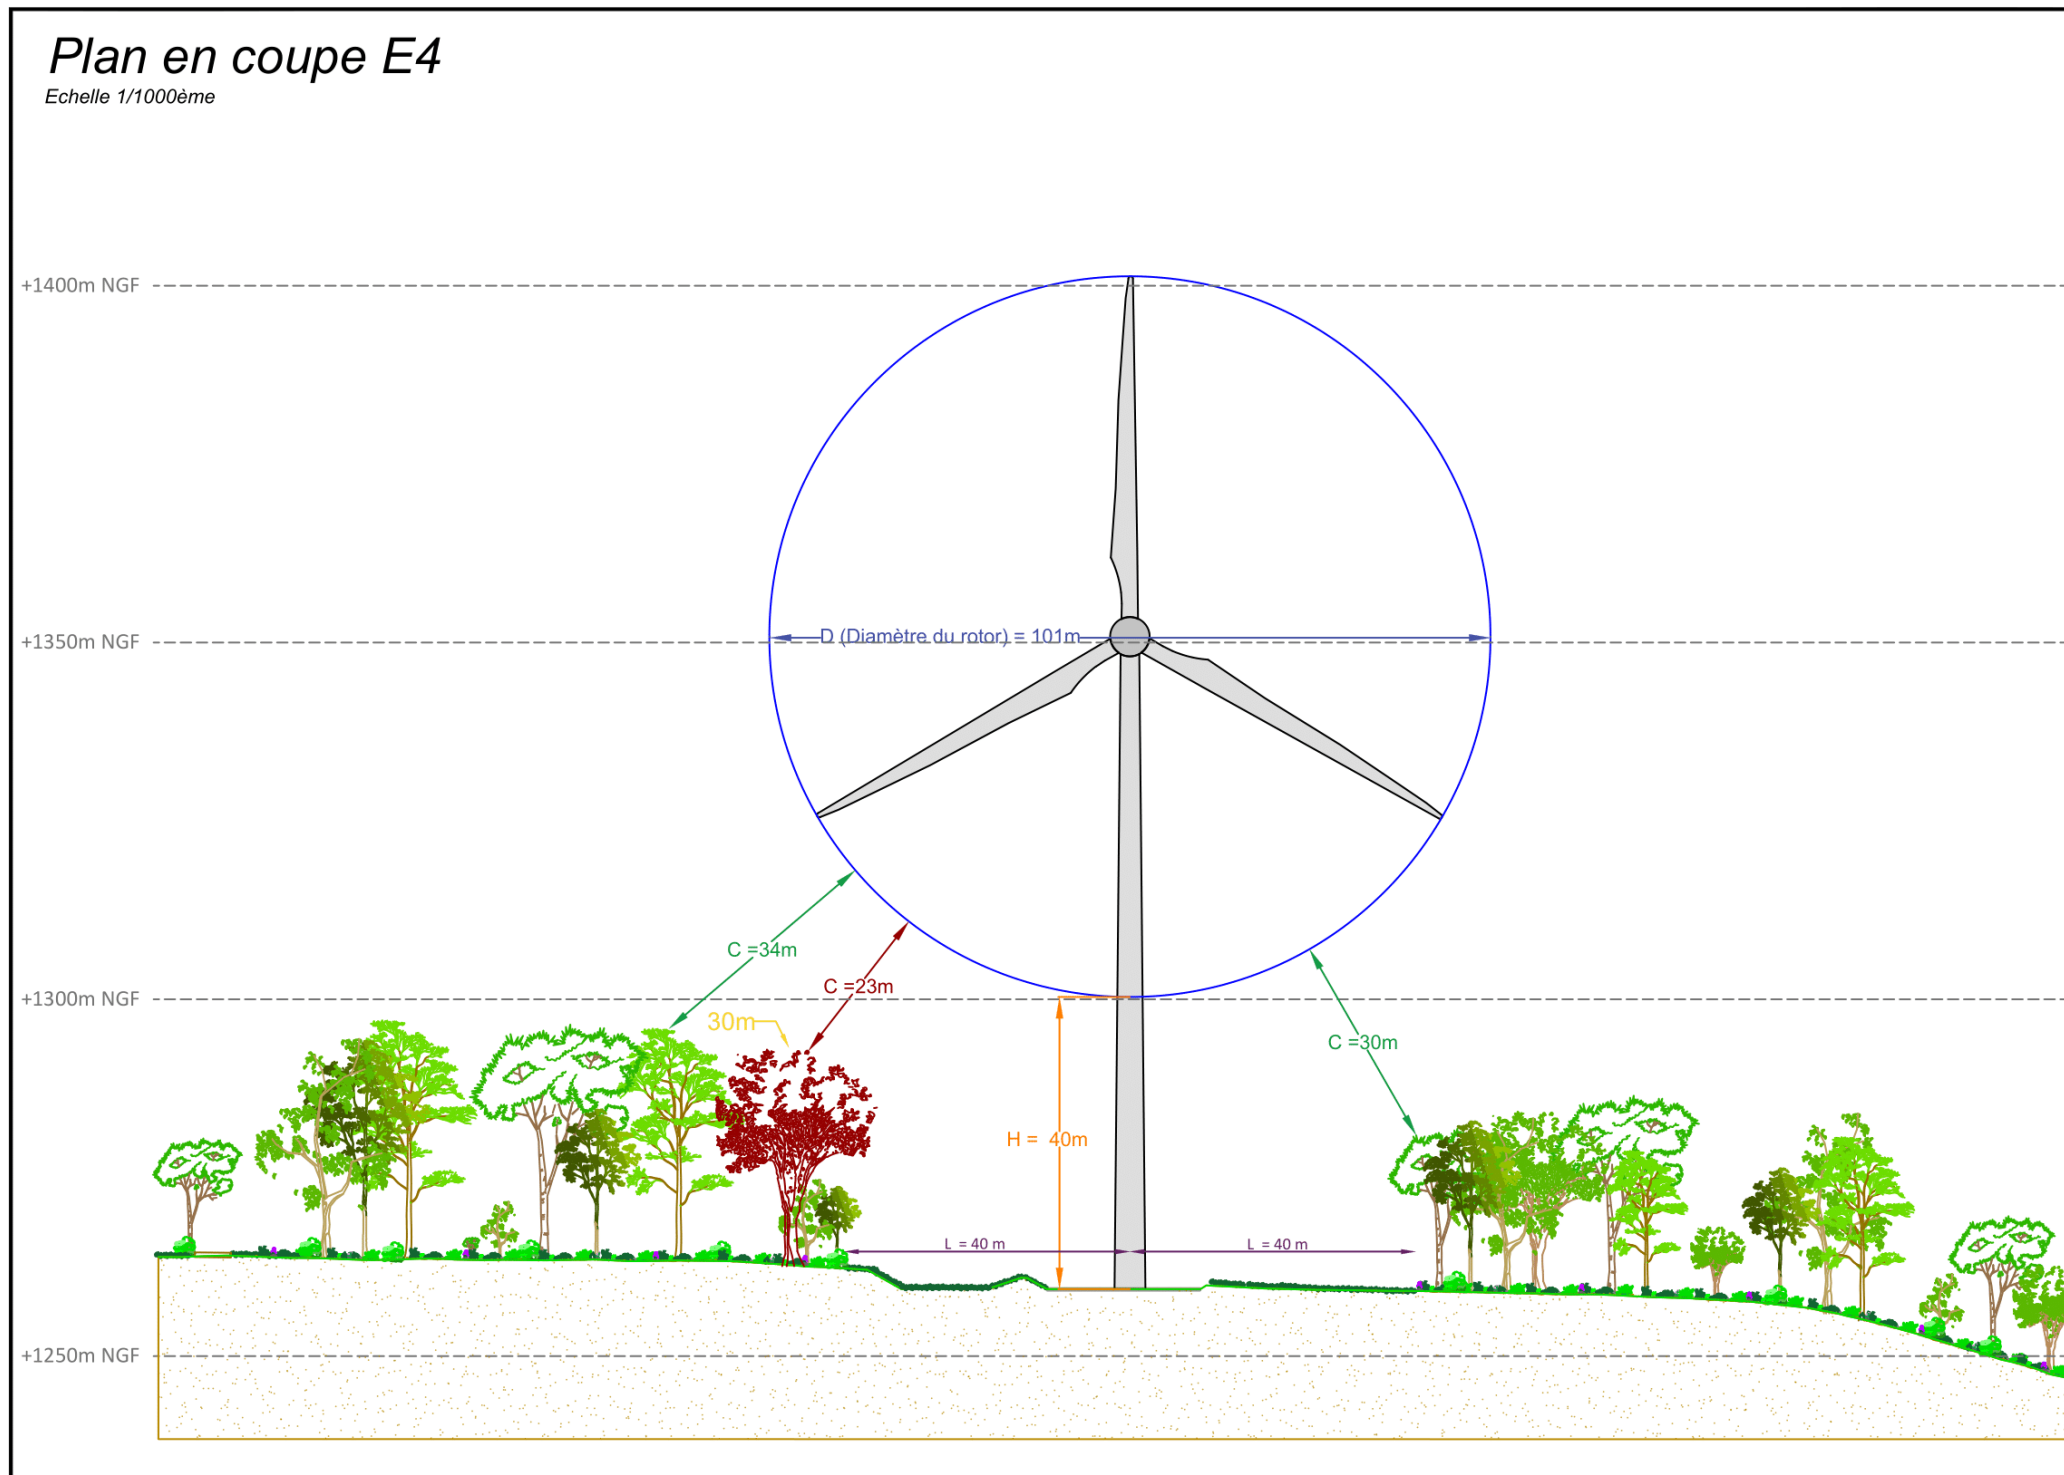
Plan de coupe et distance aux lisières (éolienne E4)
